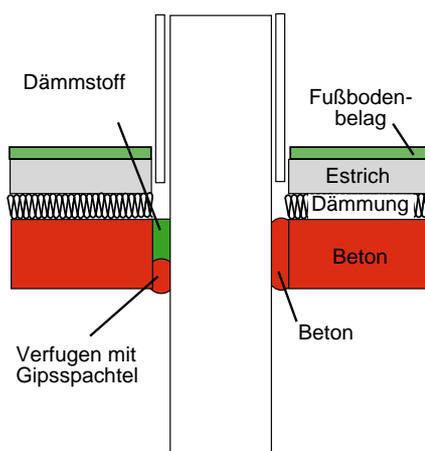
Abdichtungsvarianten für den Kamin in einer Betondecke.
